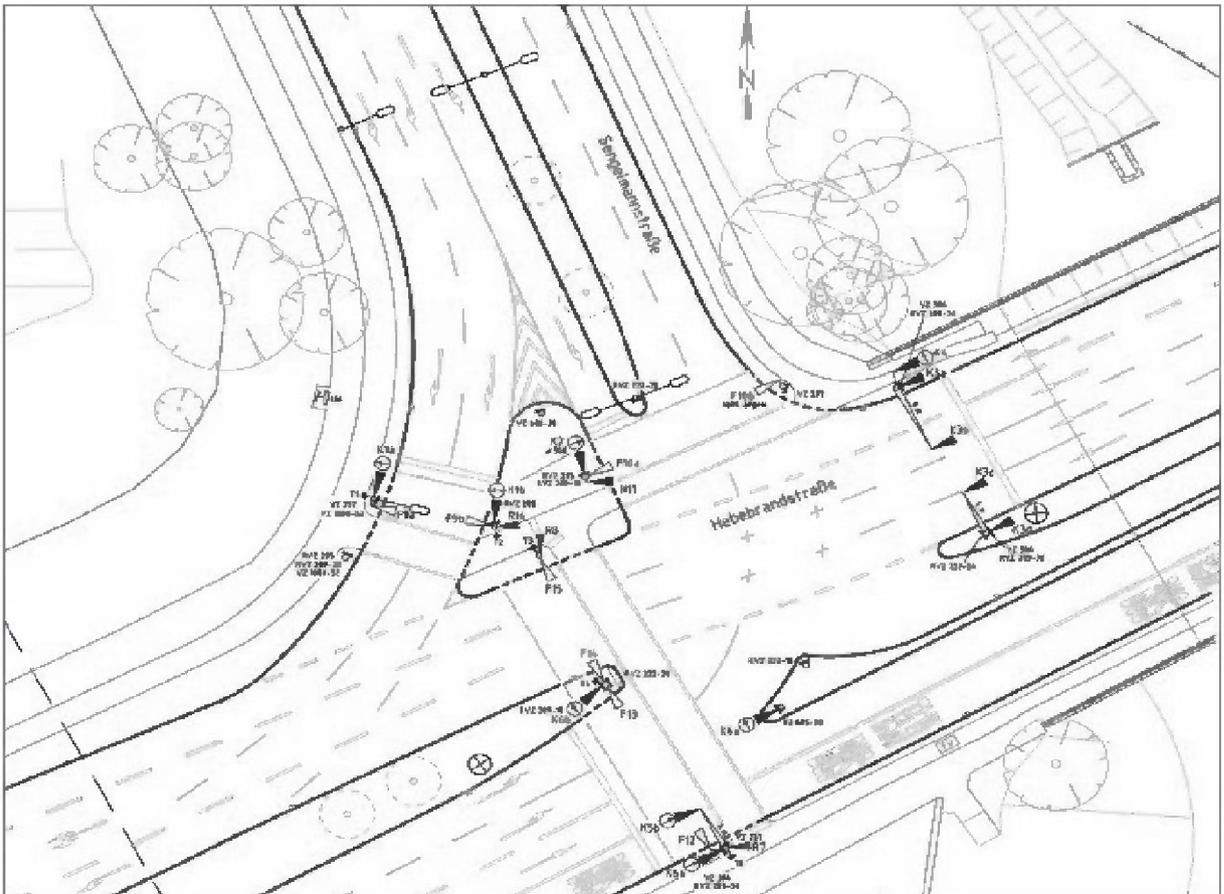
2 Signallageplanausschnitt LSA 1421
